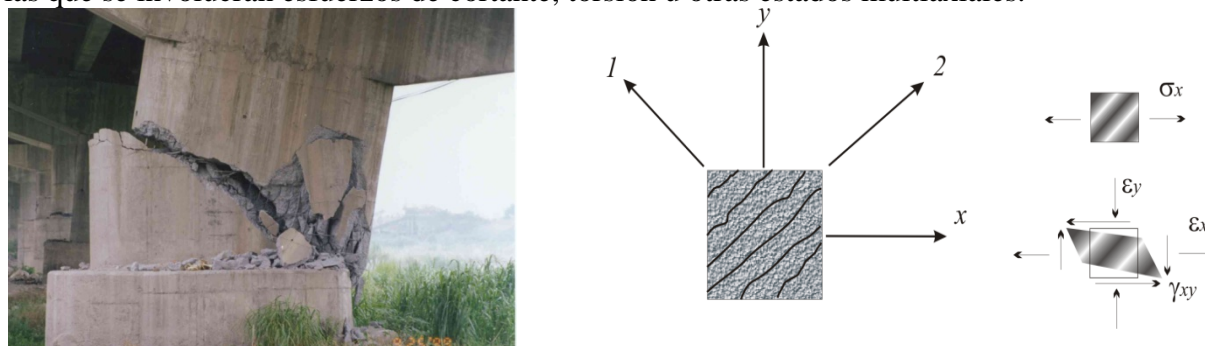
Rotura a cortante por solicitaciones sísmicas y mecanismo anisótropo del hormigón fisurado
